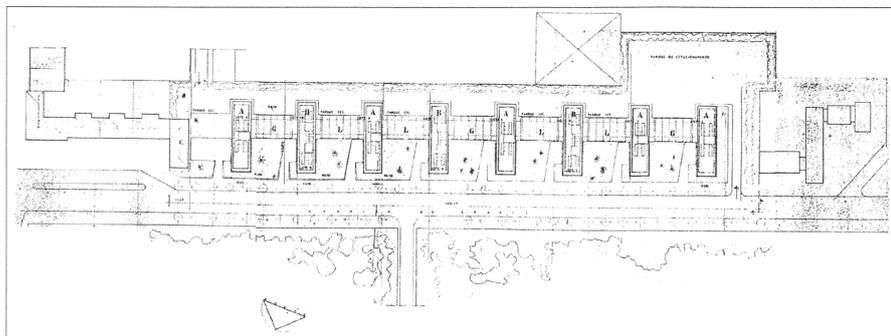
Planta do Projeto Montepio Geral – Avenida do Brasil de Jorge Segurado (1958)
